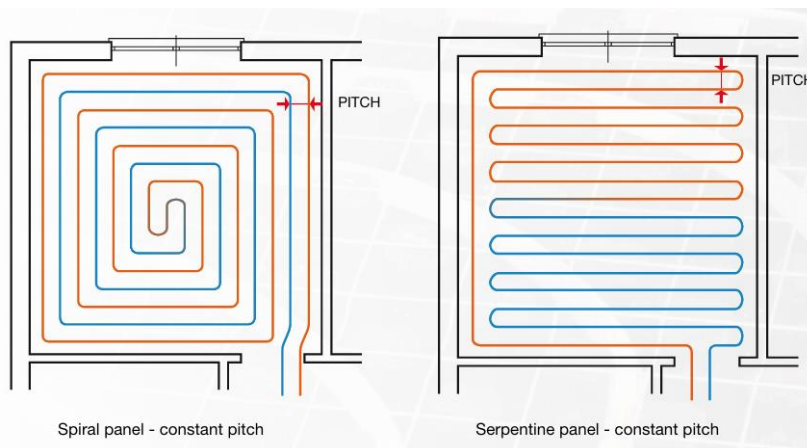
Instalação da tubagem do pavimento radiante em espiral e serpentina, com passo constante.
